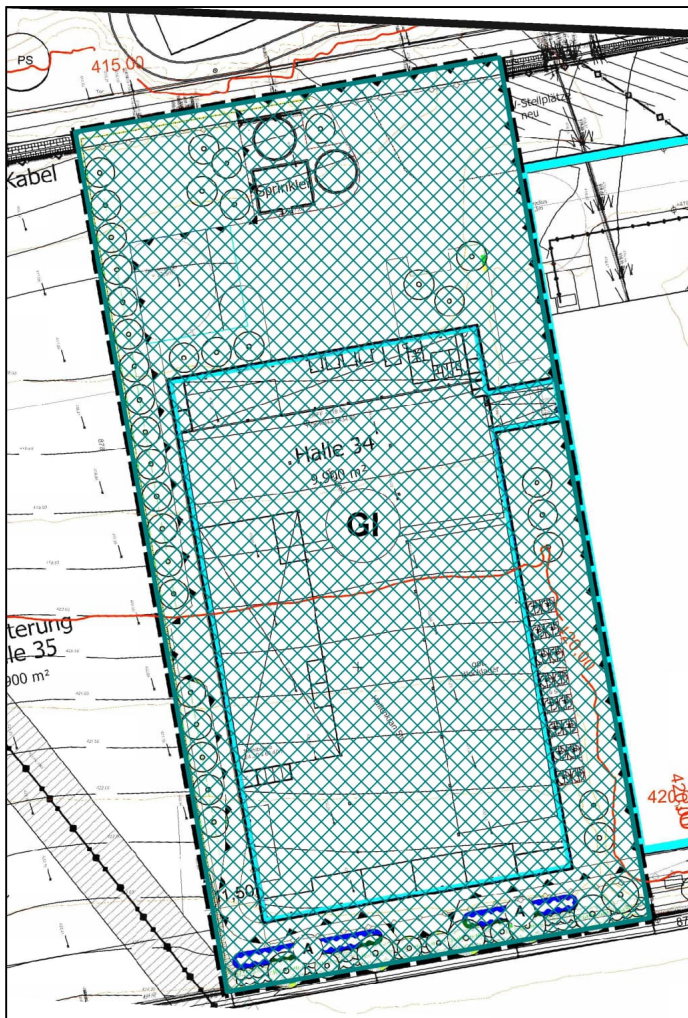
Lageplan mit Darstellung der Emissionsbezugsfläche S_{EK}
